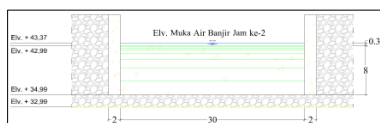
Rencana Dimensi Bangunan Pelimpah
